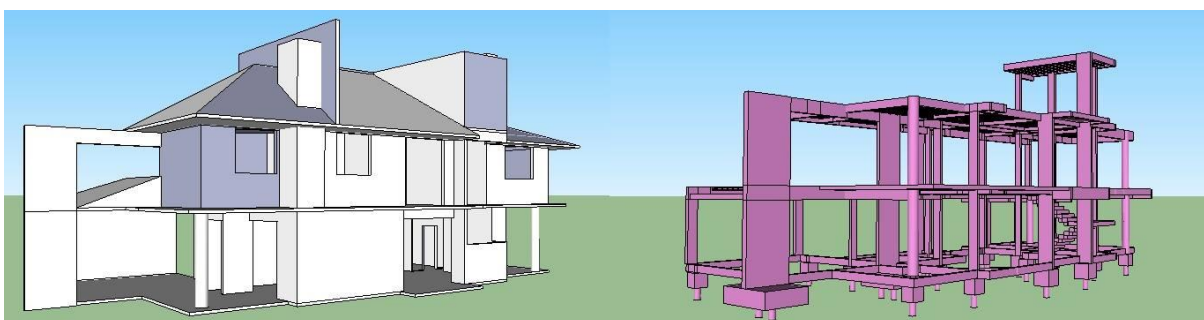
Modelo tridimensional do projeto arquitetônico e estrutural
